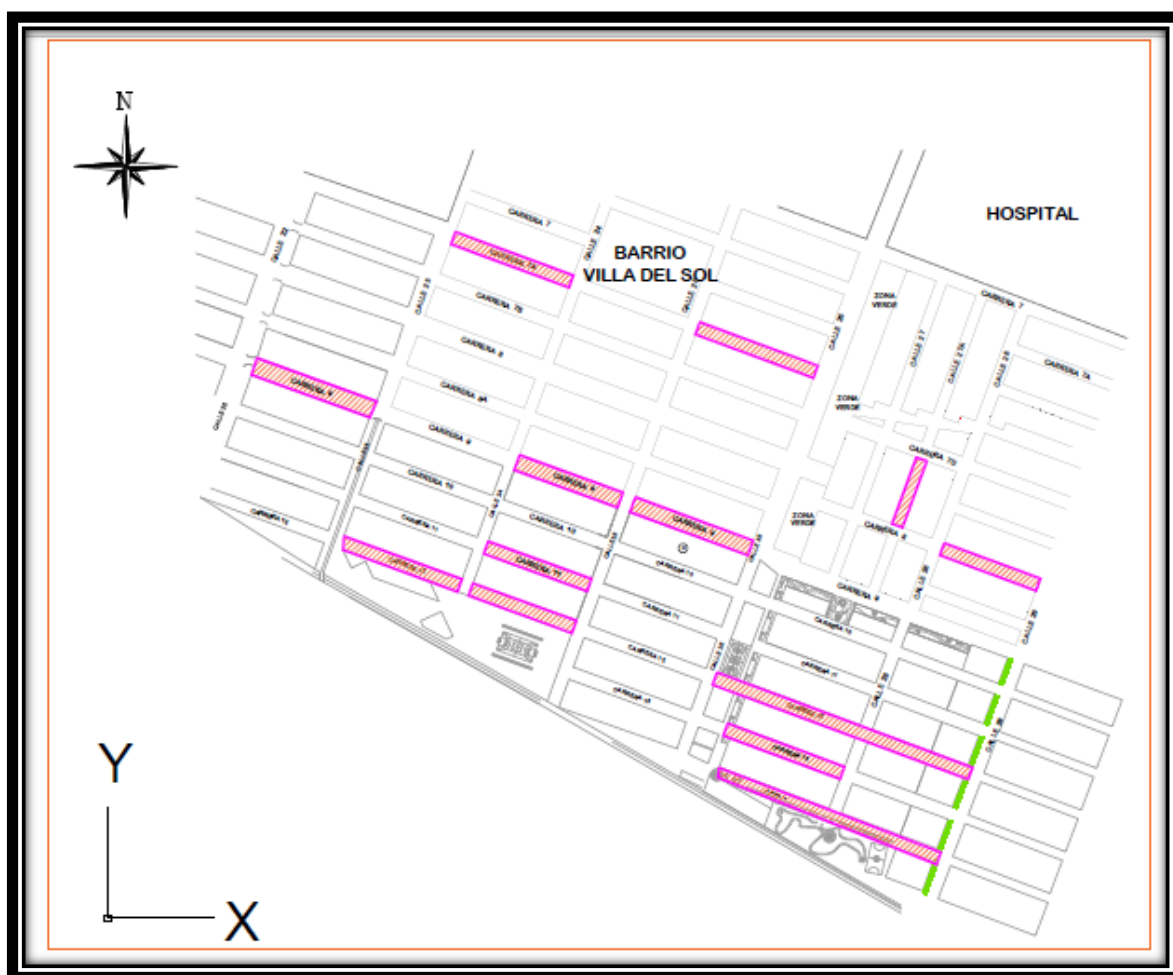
Ubicación de las calles pavimentadas en el plano del municipio.
